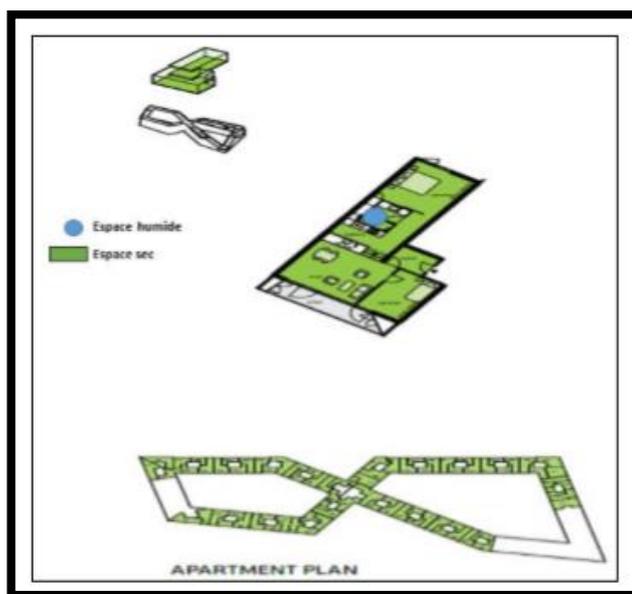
plan du 3 jusqu'à 7 eme étage.
